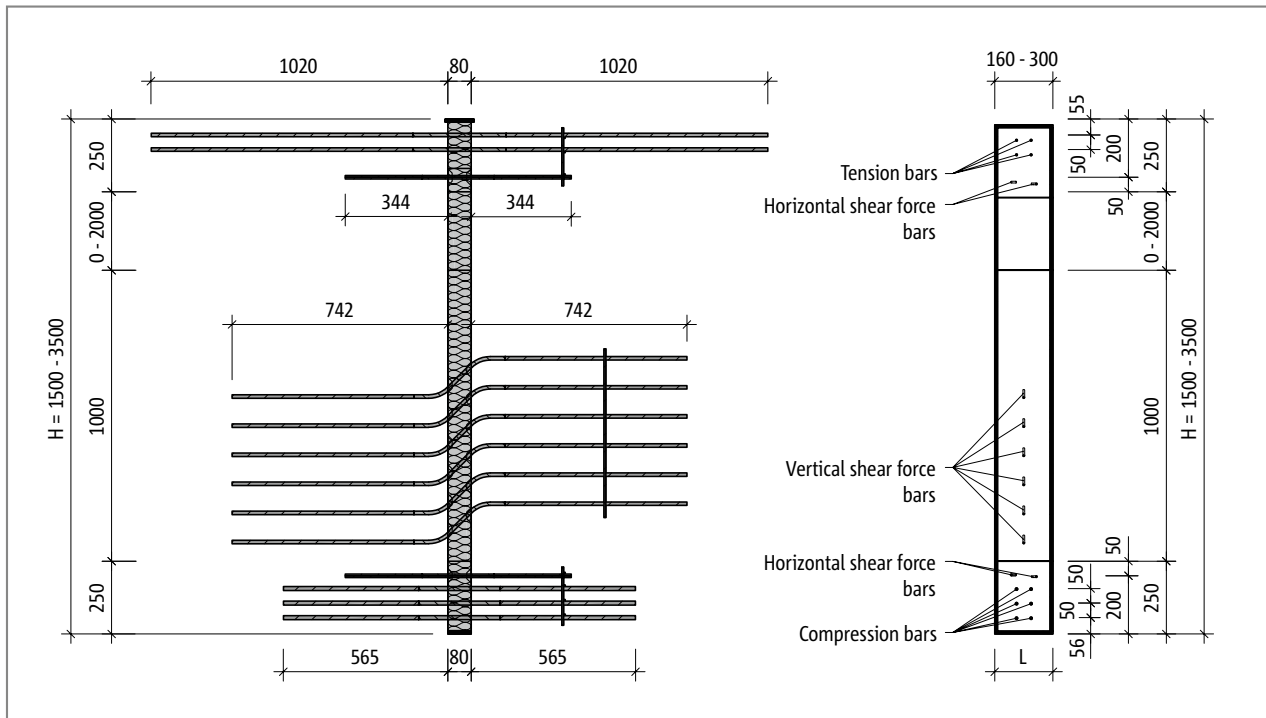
Schöck Isokorb® T type W-M4: Product section and layout
